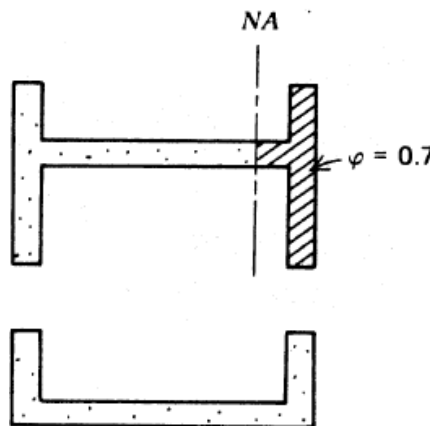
Sección transversales de muros con aletas. (Park & Paulay, 1983)
